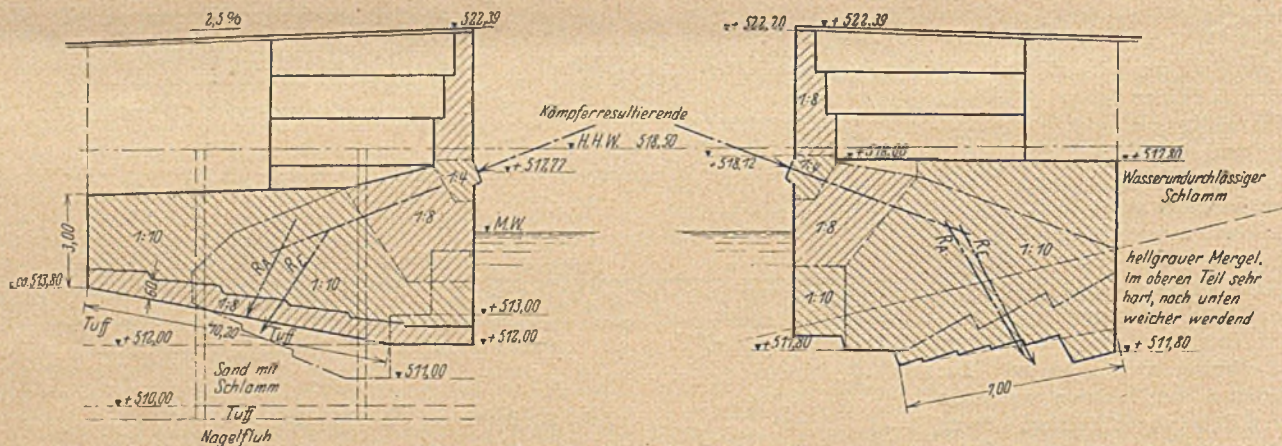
Ausgeführte Widerlager (die Umrisse der Widerlager nach dem Entwurf sind eingezeichnet).
